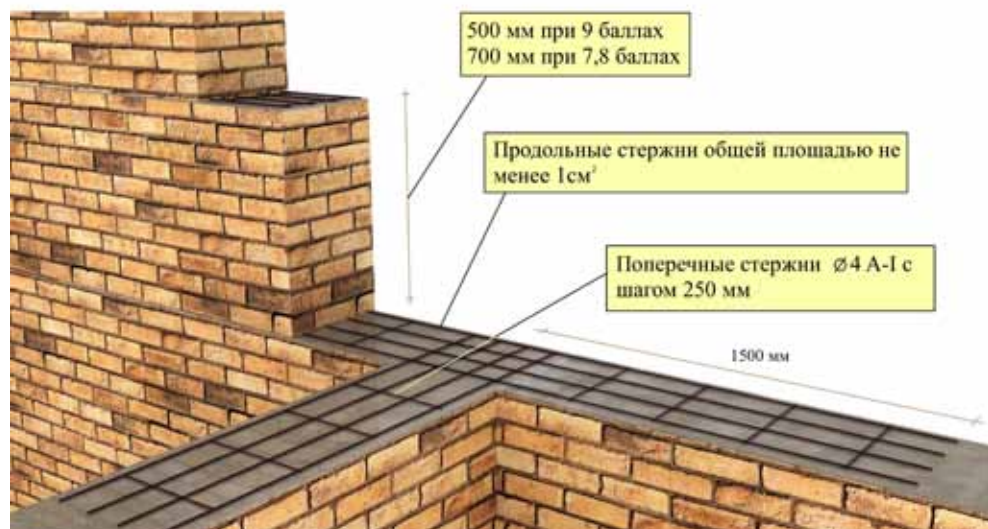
Армирование кирпичной кладки в сопряжениях наружных и внутренних стен
